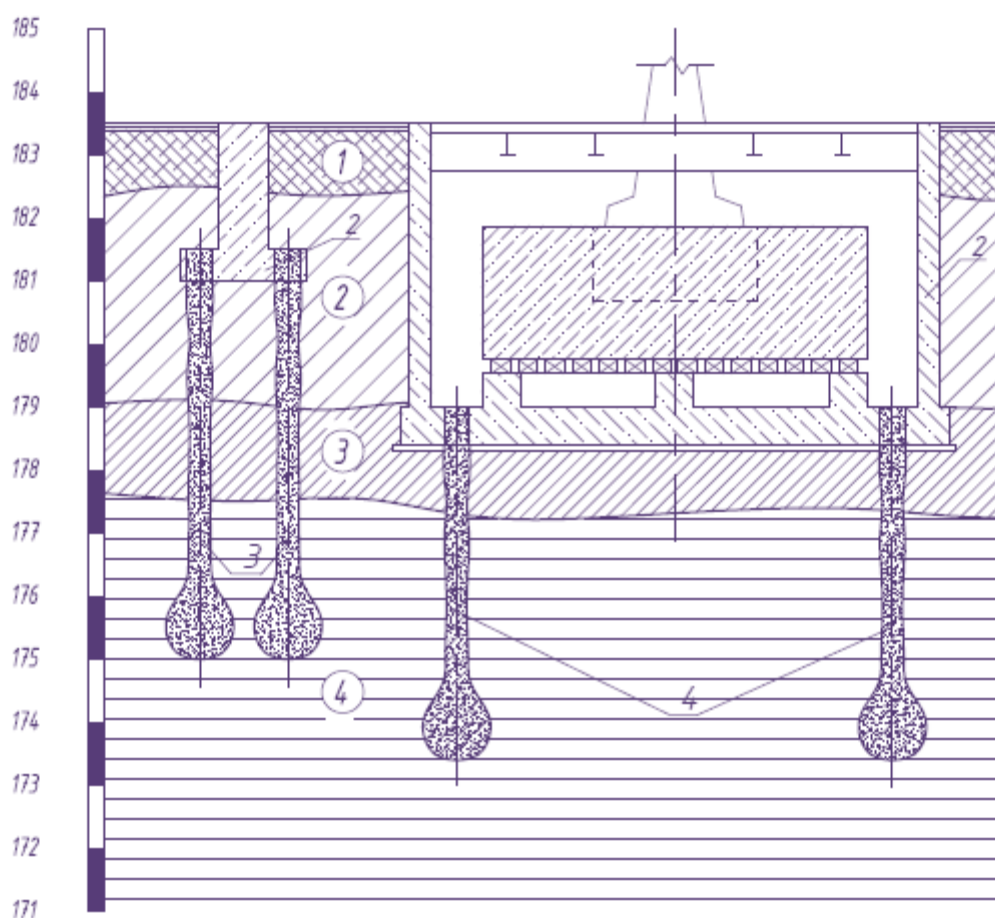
Инженерно-геологический разрез с вертикальной привязкой заглубленных железобетонных конструкций: 1 – фундамент каркаса здания, 2 – фундамент кузнечного молота, 3 – буринъекционные сваи–ЭРТ усиления основания фундаментов каркаса, 4 - буринъекционные сваи – ЭРТ усиления основания фундаментов кузнечных молотов, «1» – насыпной слой, «2» – суглиной тугопластичный, «3» – суглинок мягкопластичный, «4» – глина алевритистая тугопластичная.
